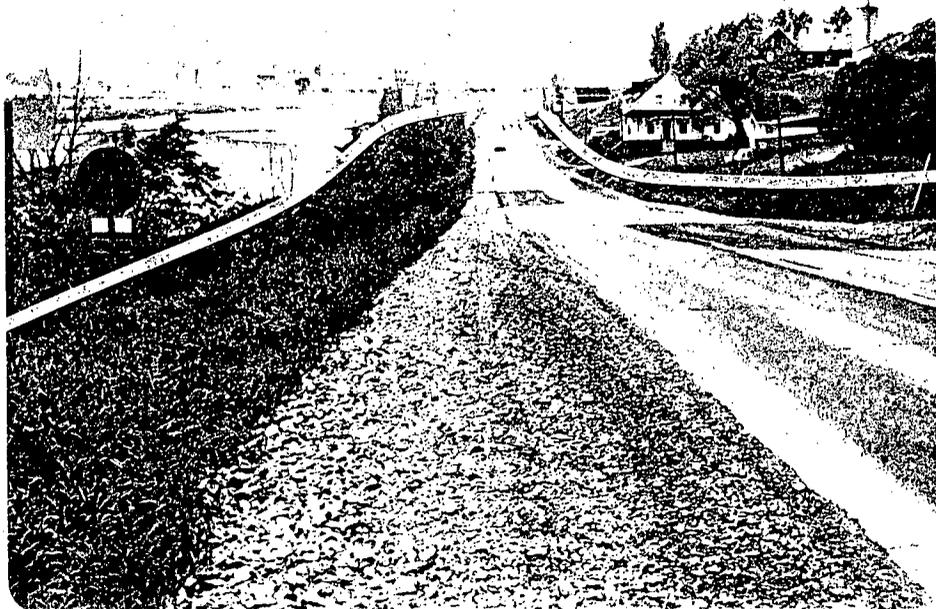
Route 173, vers Notre-Dame-des-Pins. A l'avant-plan, à gauche, on installerait des murs en béton.
